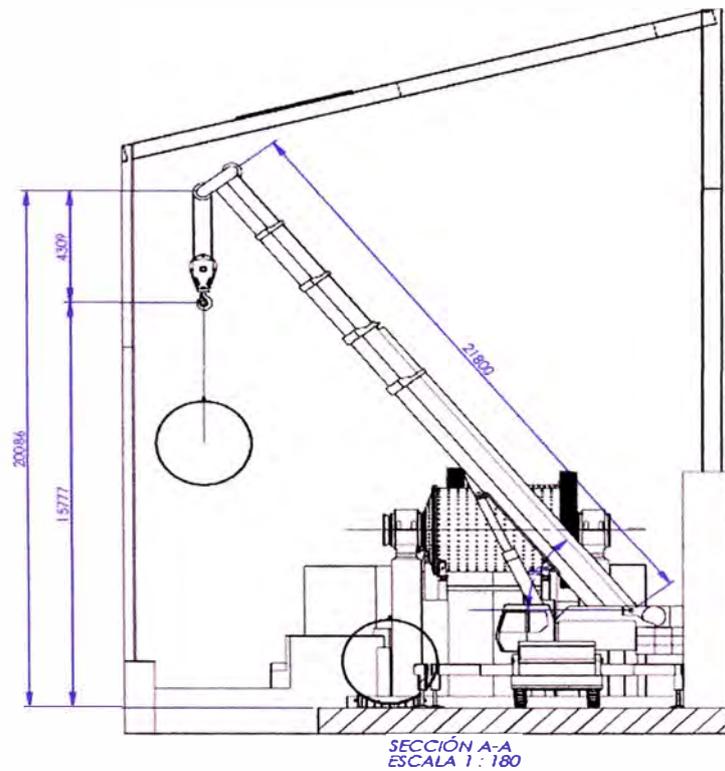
Vista frontal del rigging plan – Montaje de de Shell del Molino de Barras
